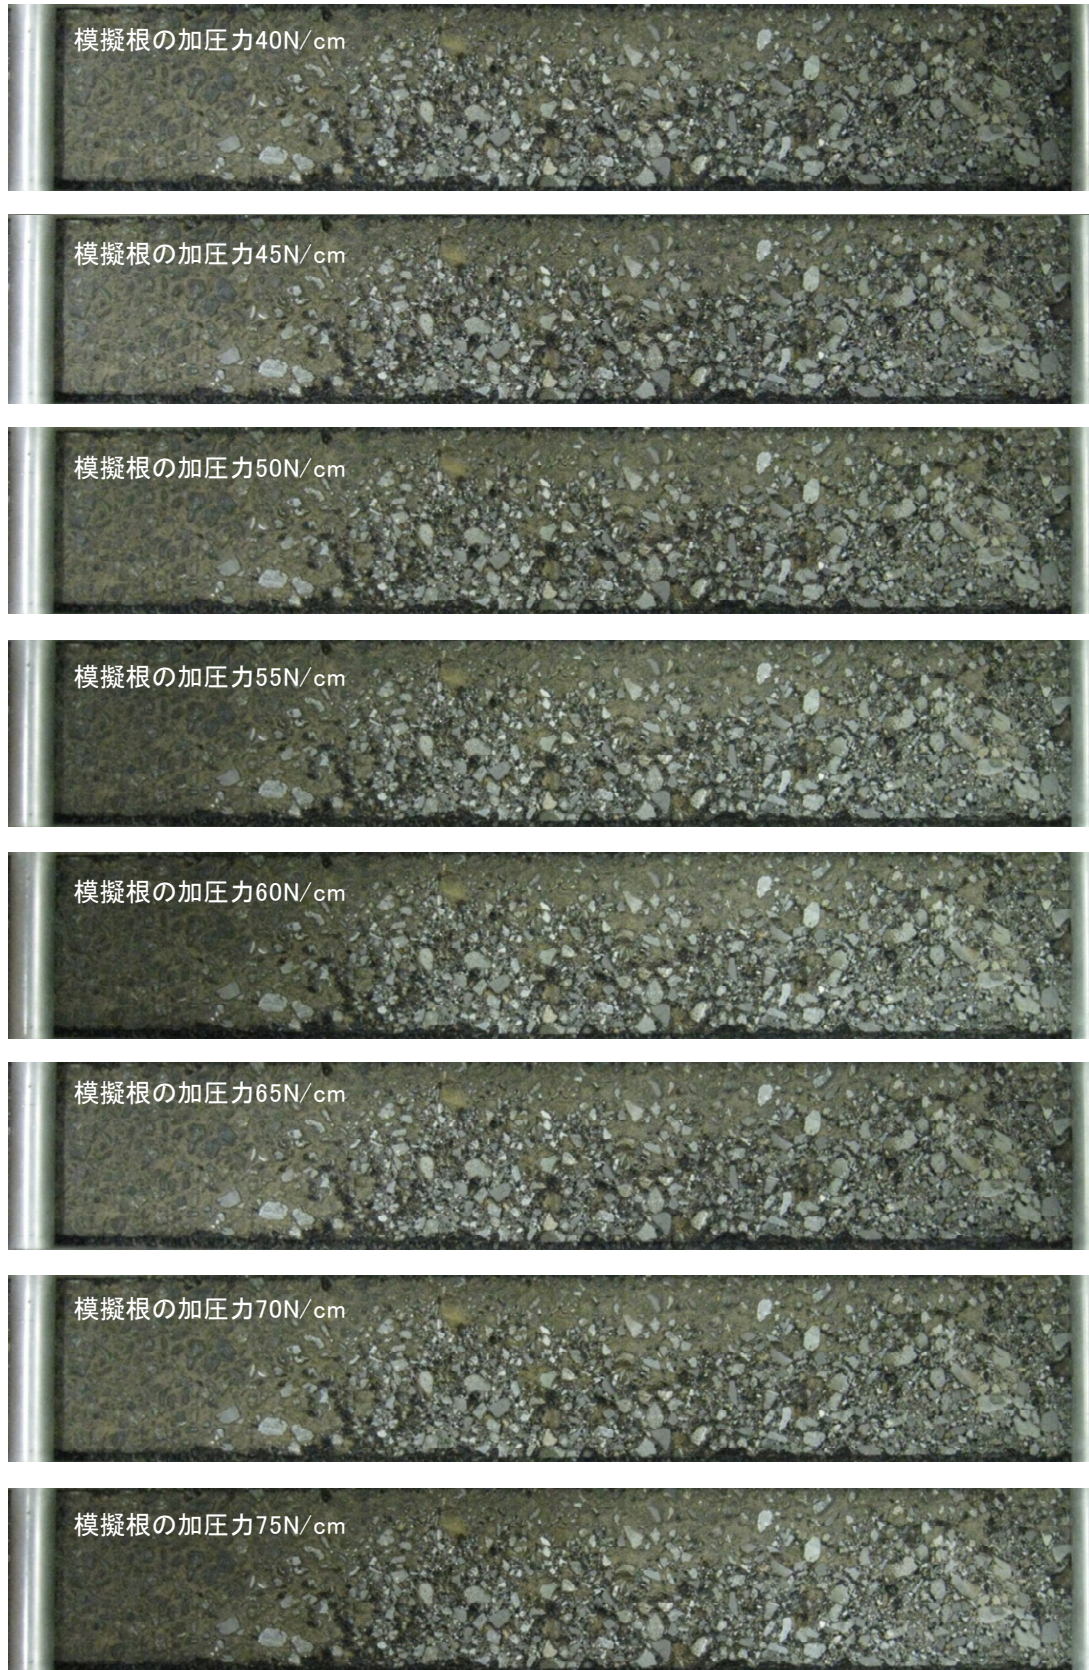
アスファルト舗装表面のひび割れ状態の一例(模擬根直上の砂層の厚さ50mm) 2/3
